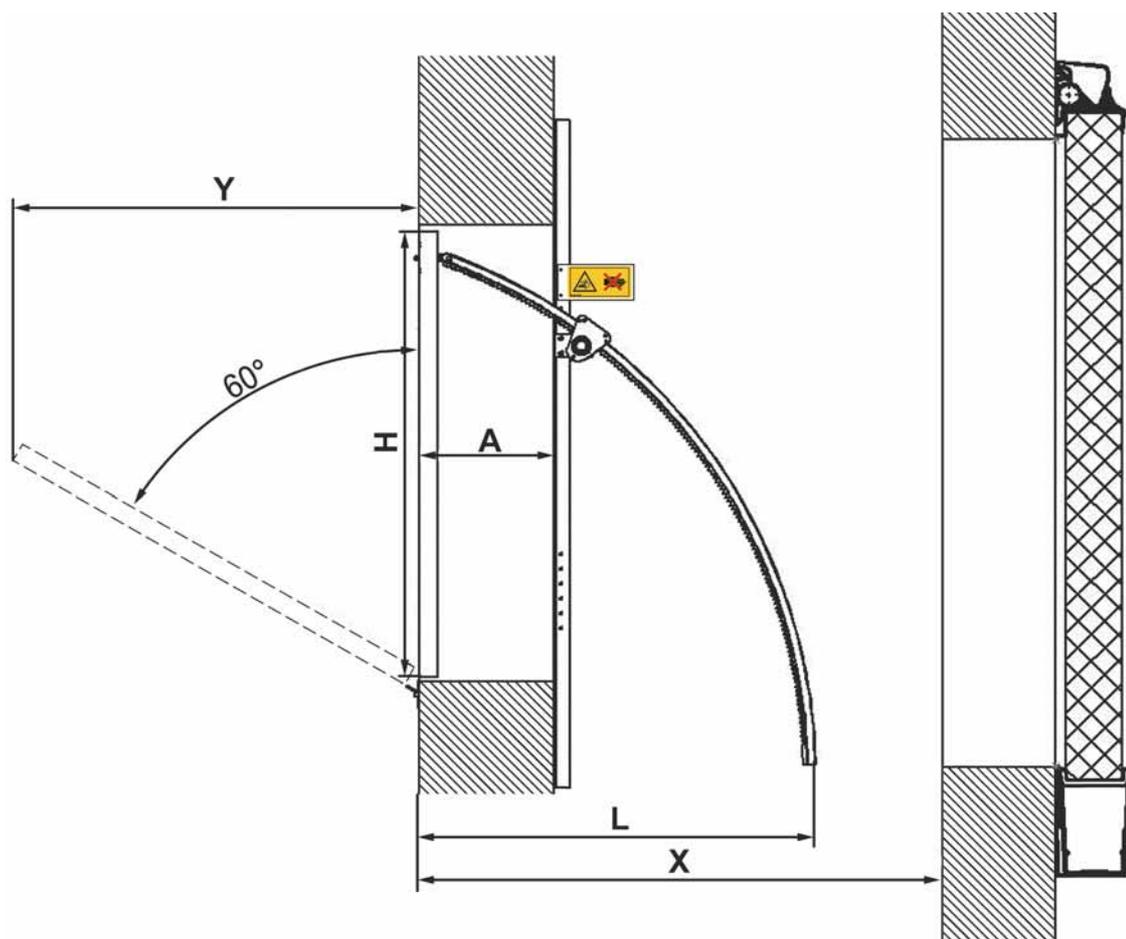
Maße der Tunnelklappe (60° = maximale Öffnung)
